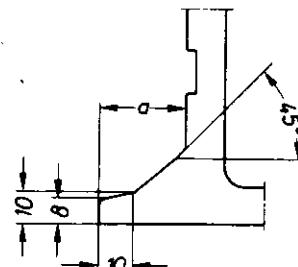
Fußleiste der Deckenziegel für Stahlbetonrippendecken
